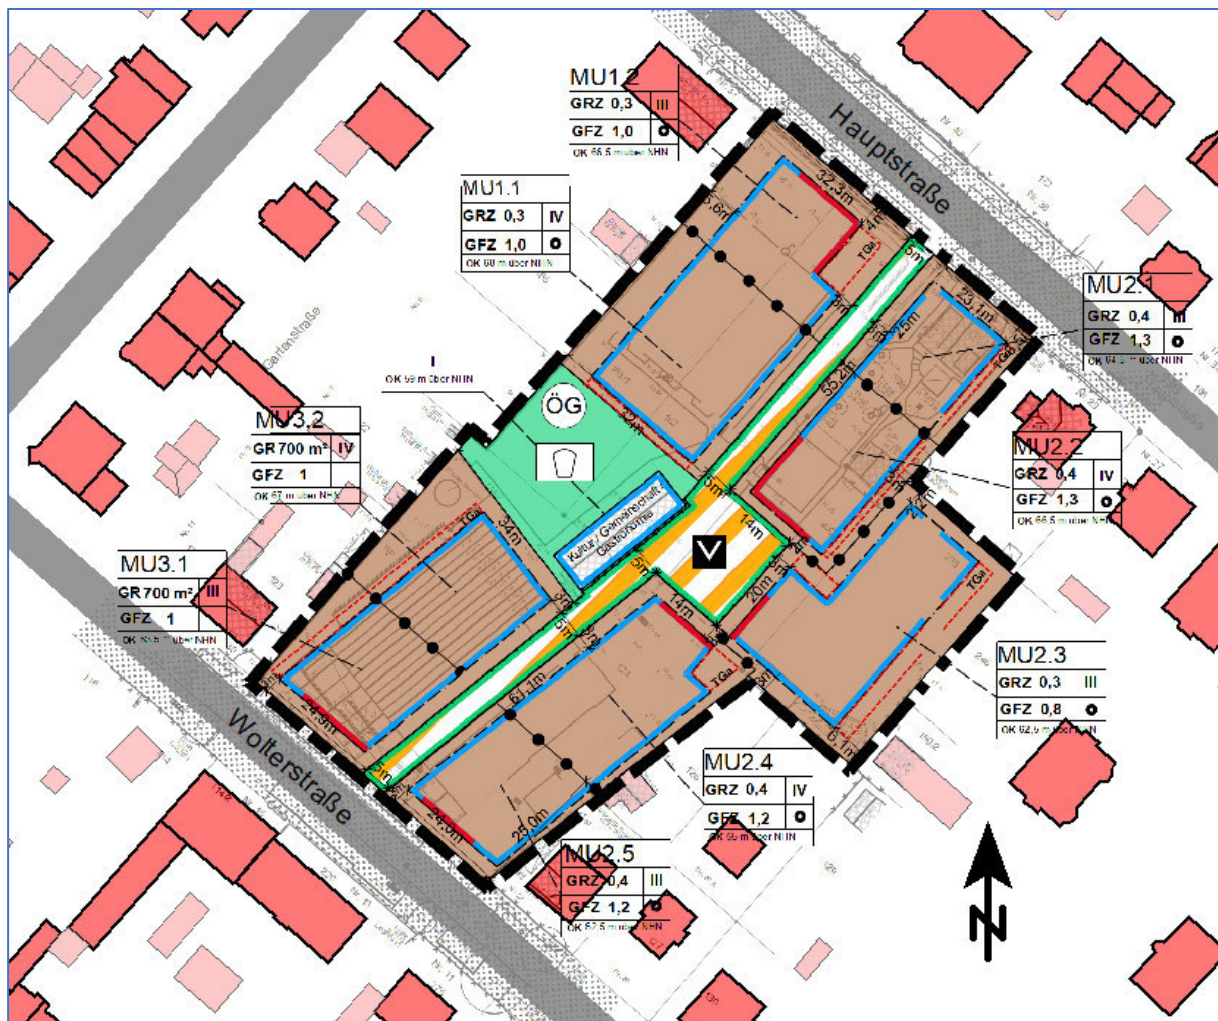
Planzeichnung des Bebauungsplans [A]
